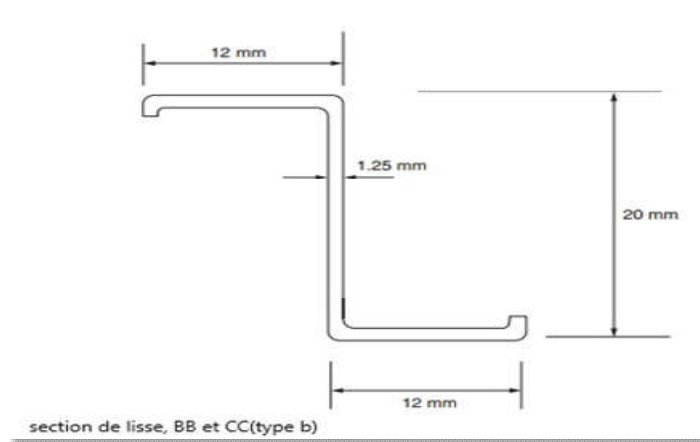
b Section des lisses dans la section CC a la section BB (type B)
